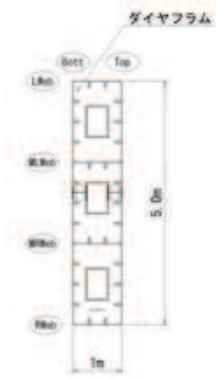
(2) 鋼製遮水壁 (鋼桁 5) 平面図
